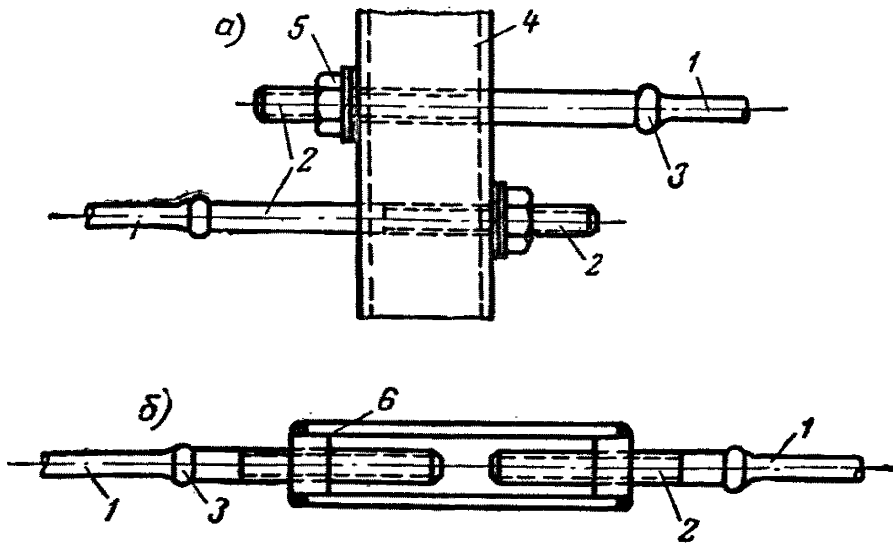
Анкеровка и стыкование арматуры в предварительно напряженных железобетонных резервуарах
